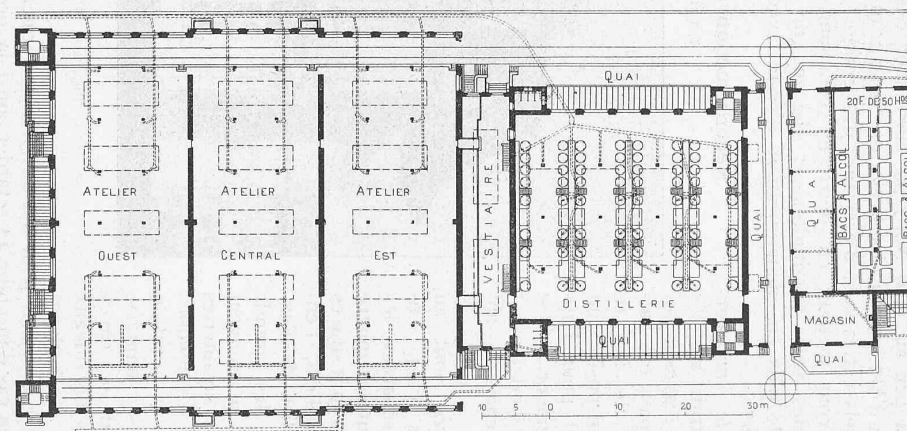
Plan du rez-de-chaussée. — Echelle 1 : 1000.
